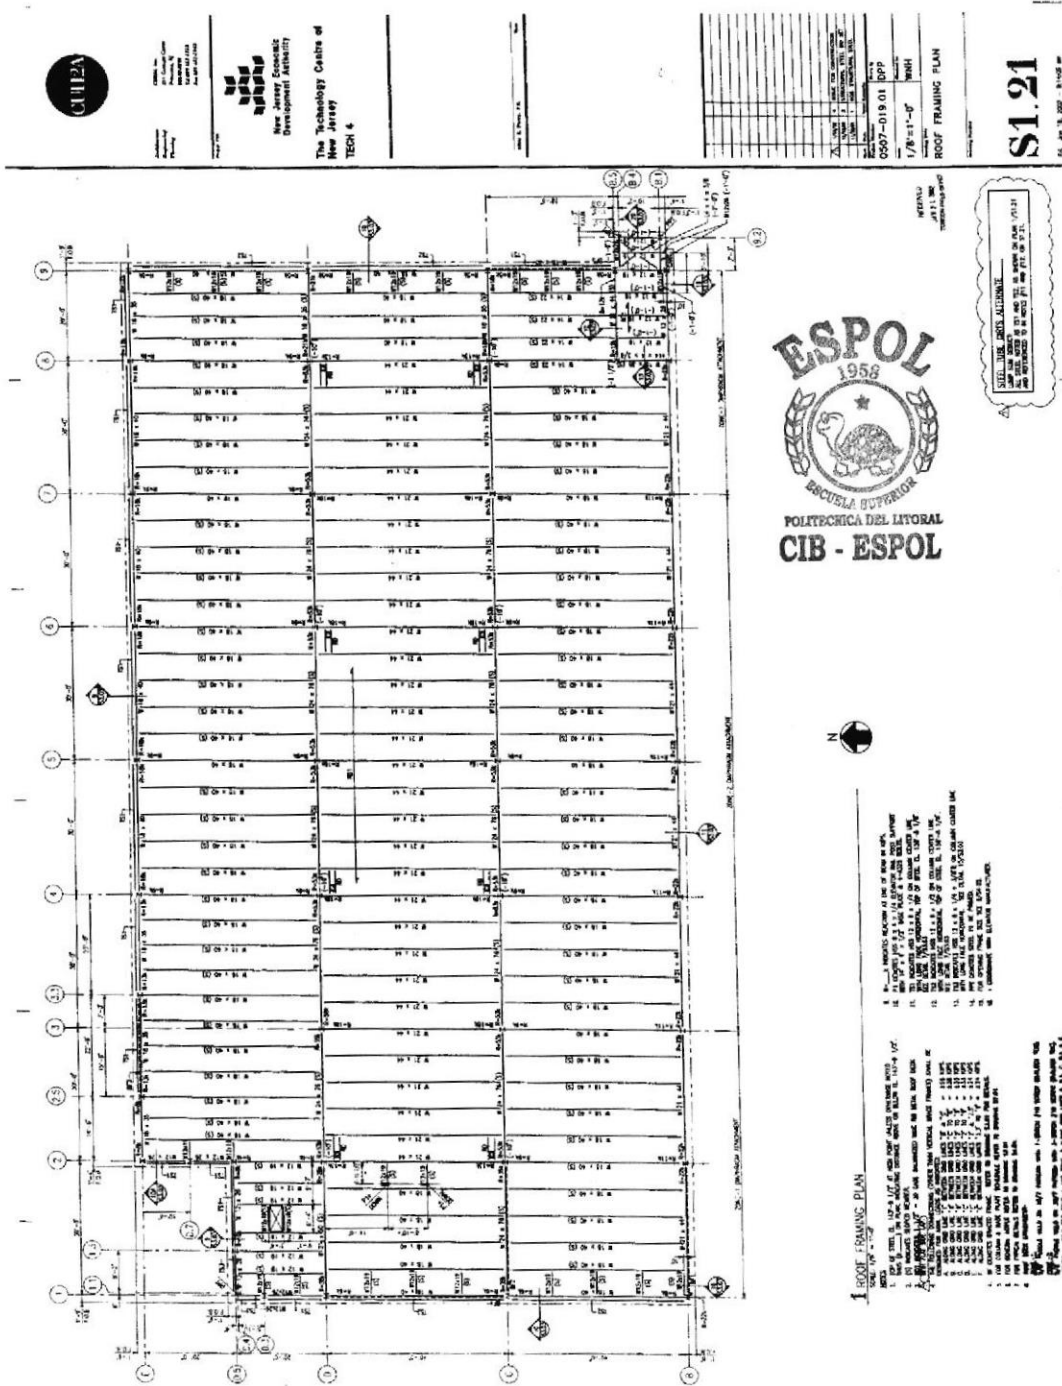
Plano estructural de la cubierta superior del proyecto en estudio "TECH 4 / NJ"
